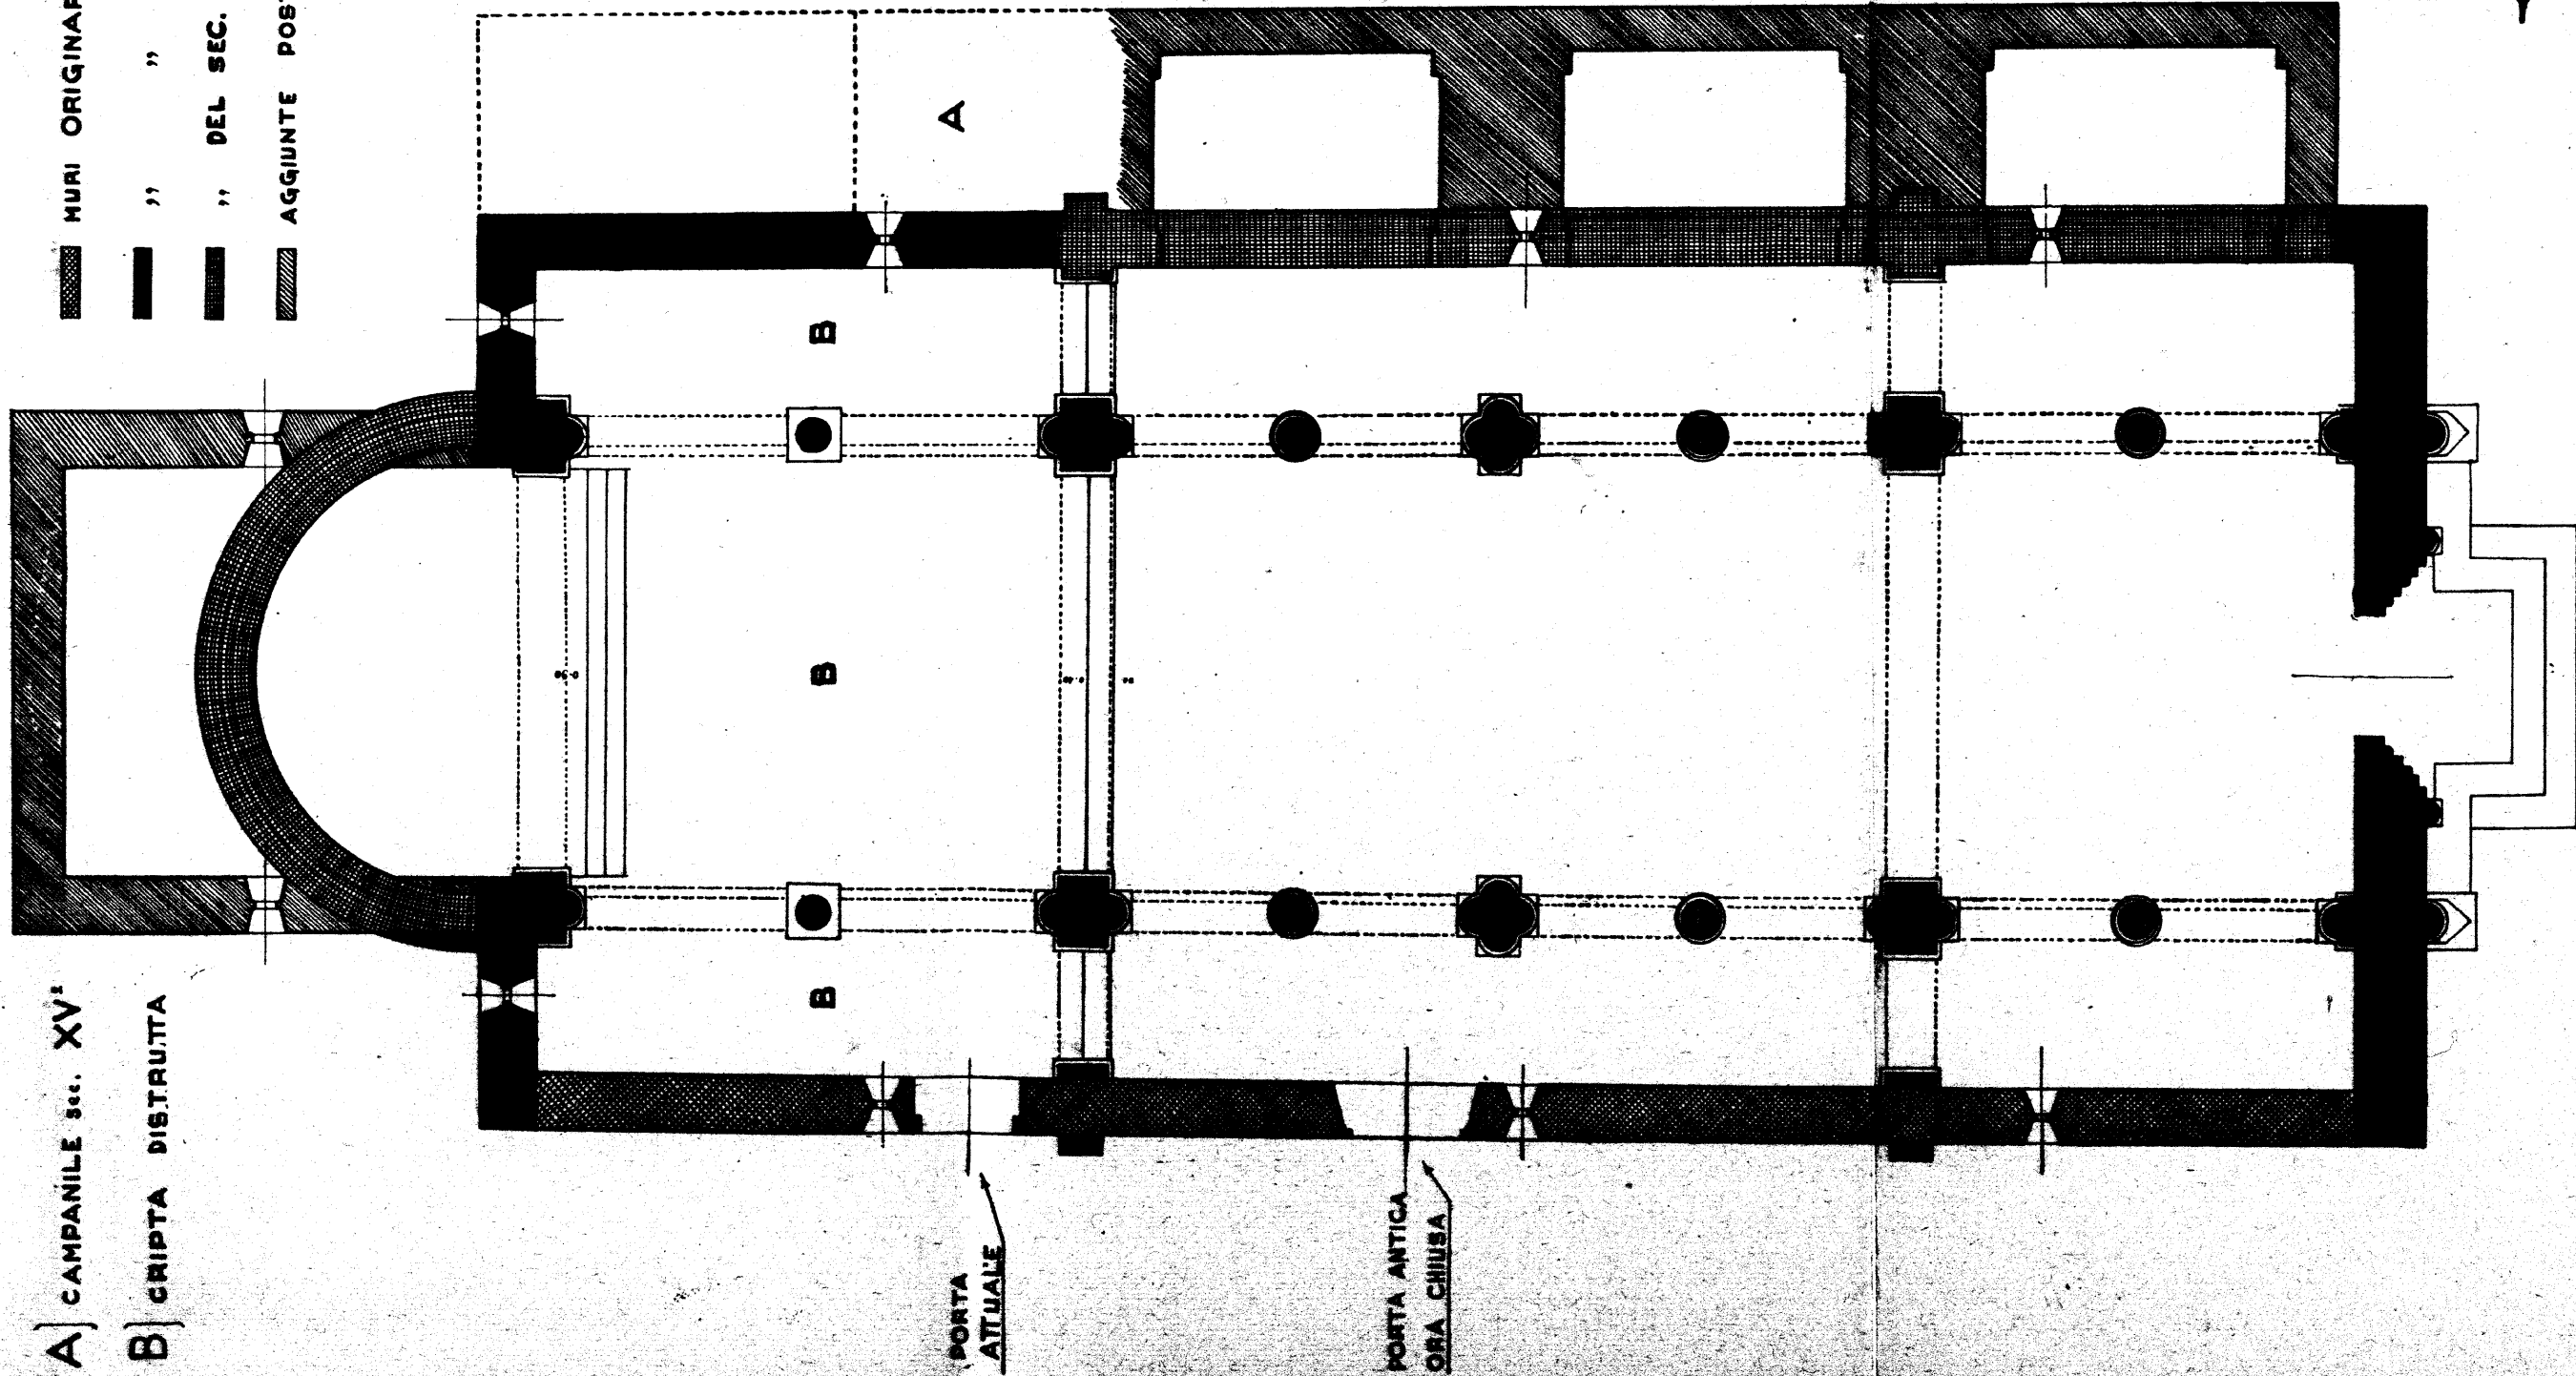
Fig. XXI - MADERNO, S. ANDREA: PIANTA
